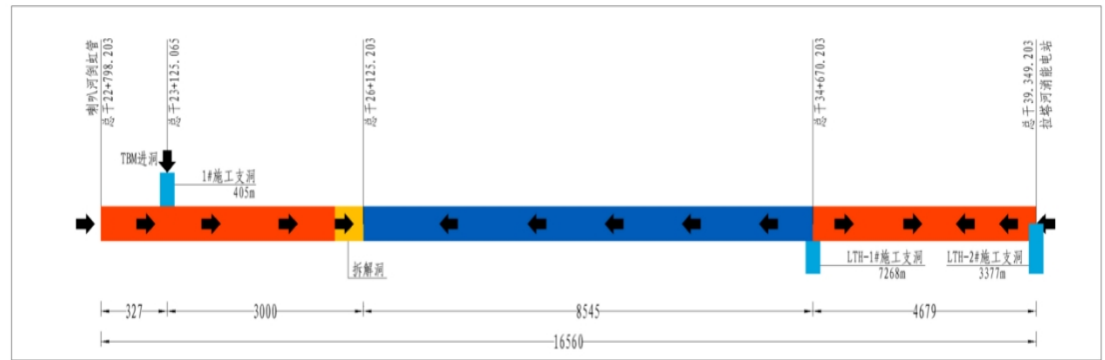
老君山隧洞施工方案示意图 (TBM+爆破)
